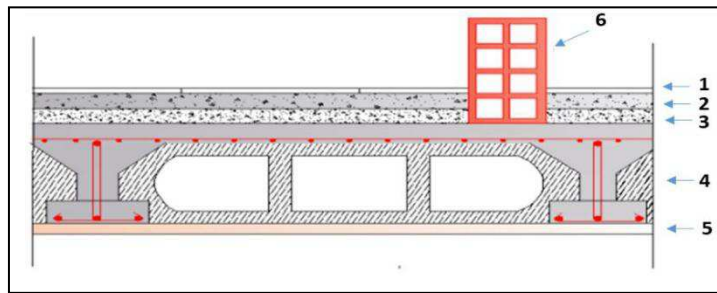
Coupe verticale d'un plancher à corps creux de l'étage courant.
